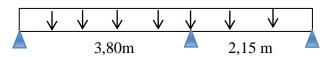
Schéma statique de poutrelles (Type 05) d'étage courant.
